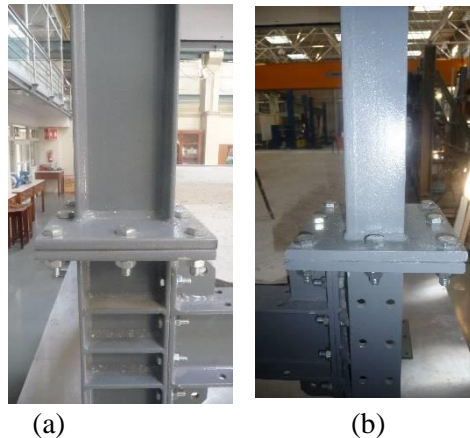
Ligação Pilar-Pilar (a) direção de maior inércia; (b) direção de menor inércia
